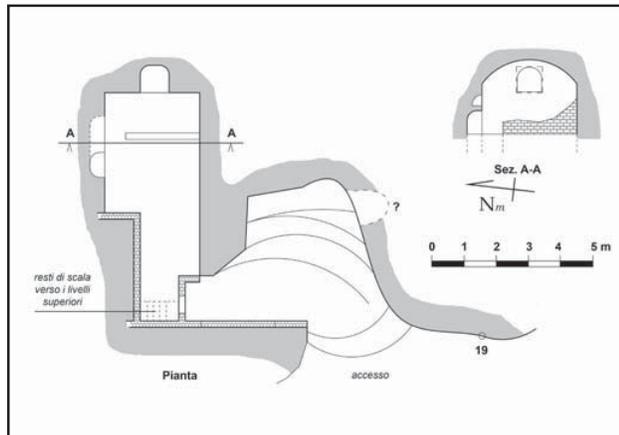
Planimetria e sezione dell'ipogeo n. 19 Chiesa di Santa Maria del Confalone (Copyright CRSE).
